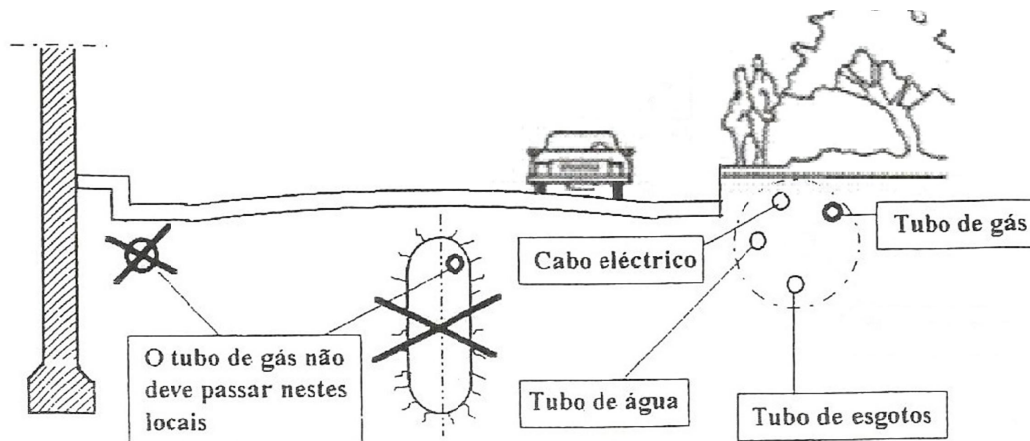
Localização das redes enterradas (adaptado [12]).
